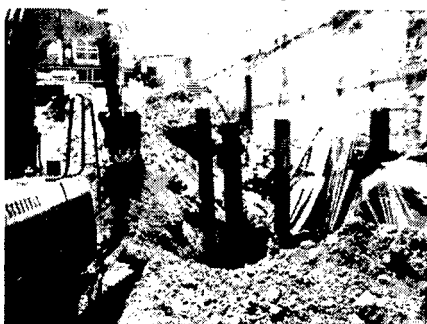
Detalhe de área escavada e estacadas fixadas na porção Oeste do terreno.
